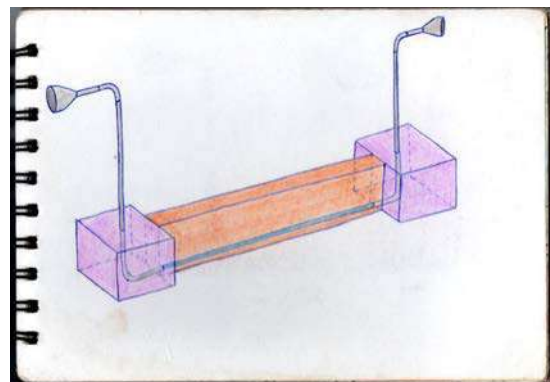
Perspectiva con detalle de cimentación de los teléfonos de tubo. Elaboración propia
